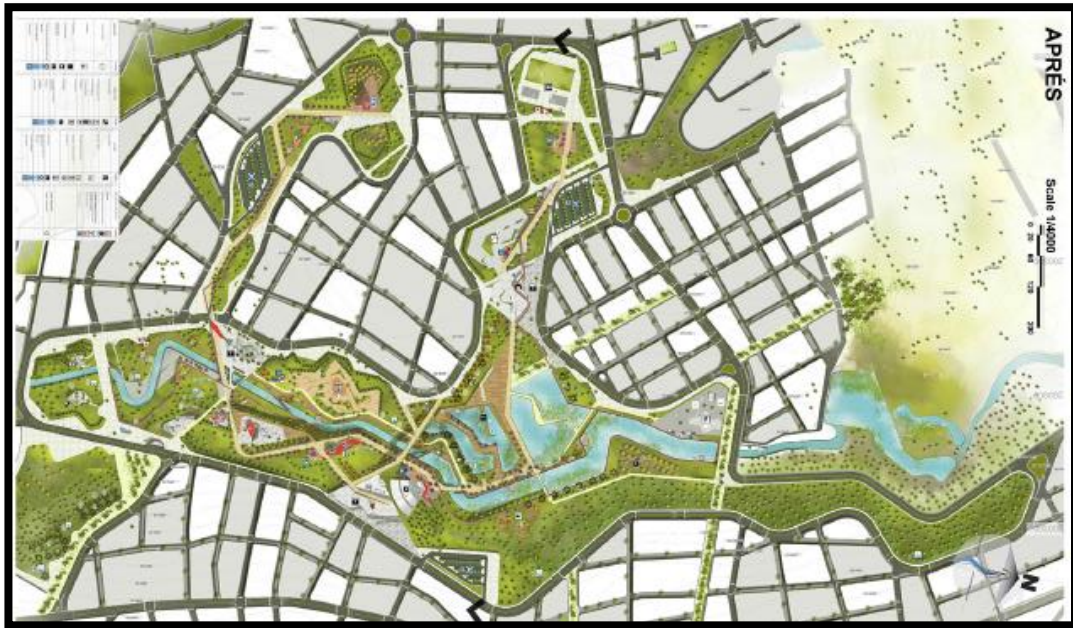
Plan de masse. Projet de Sucre, Bolivie
